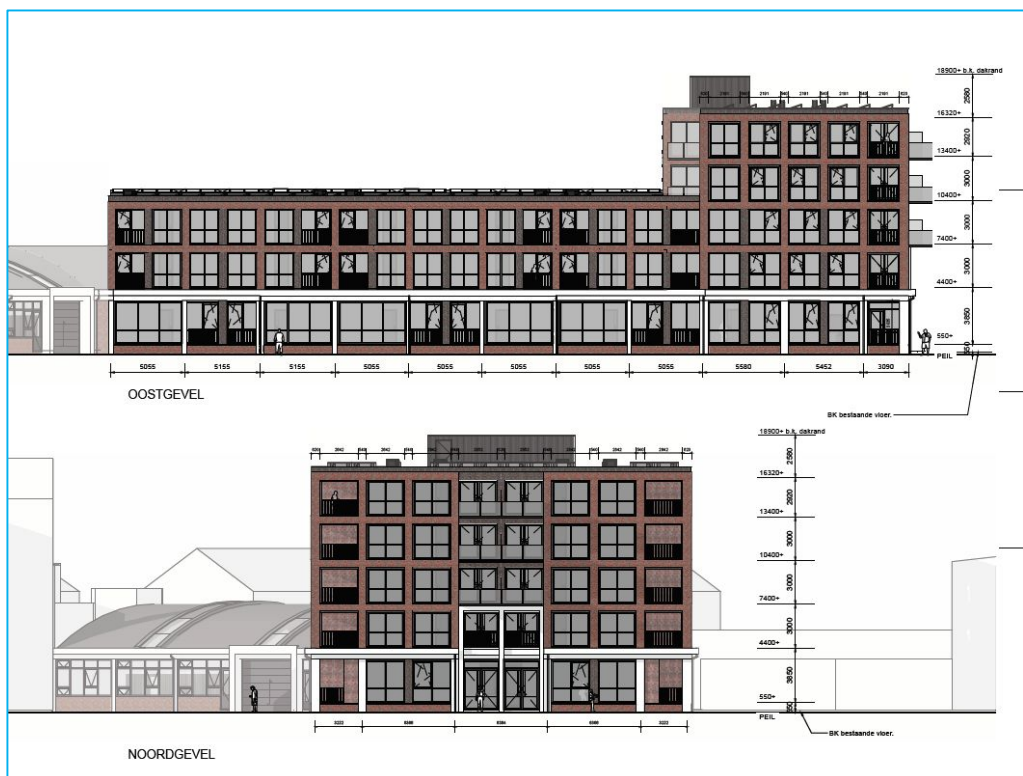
Weergave van het bouwplan vanaf straatniveau
